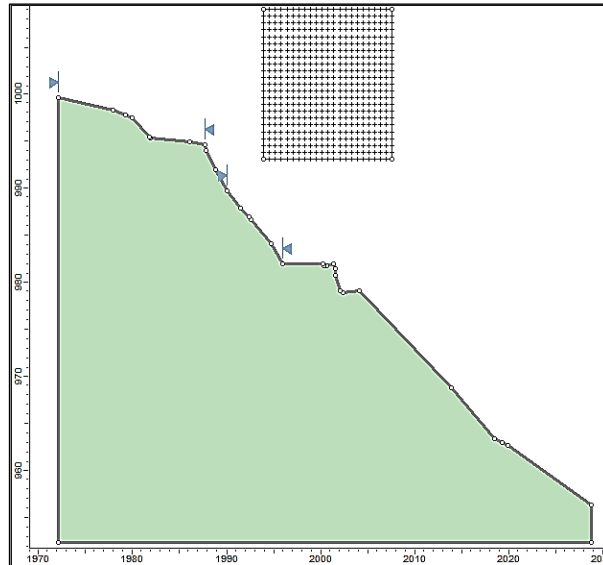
Sección transversal corte A-A, importado del CivilCAD 3D.
